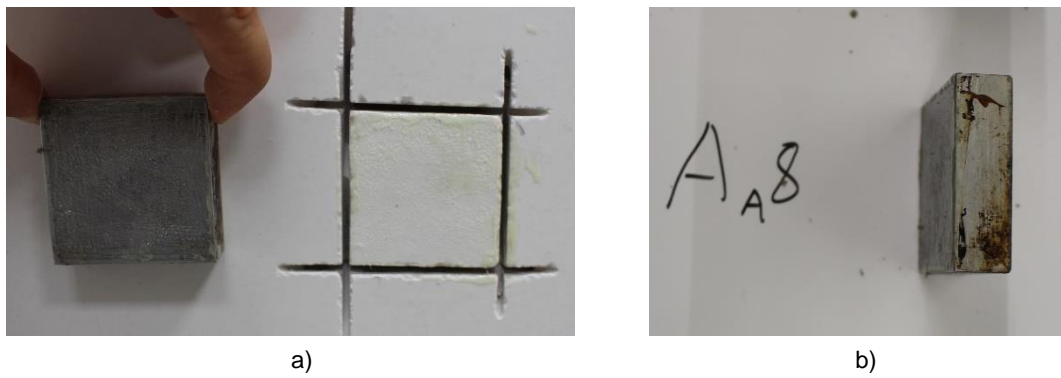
Ensaio de aderência Aa8: a) Vista de frente; b) Vista em perfil
